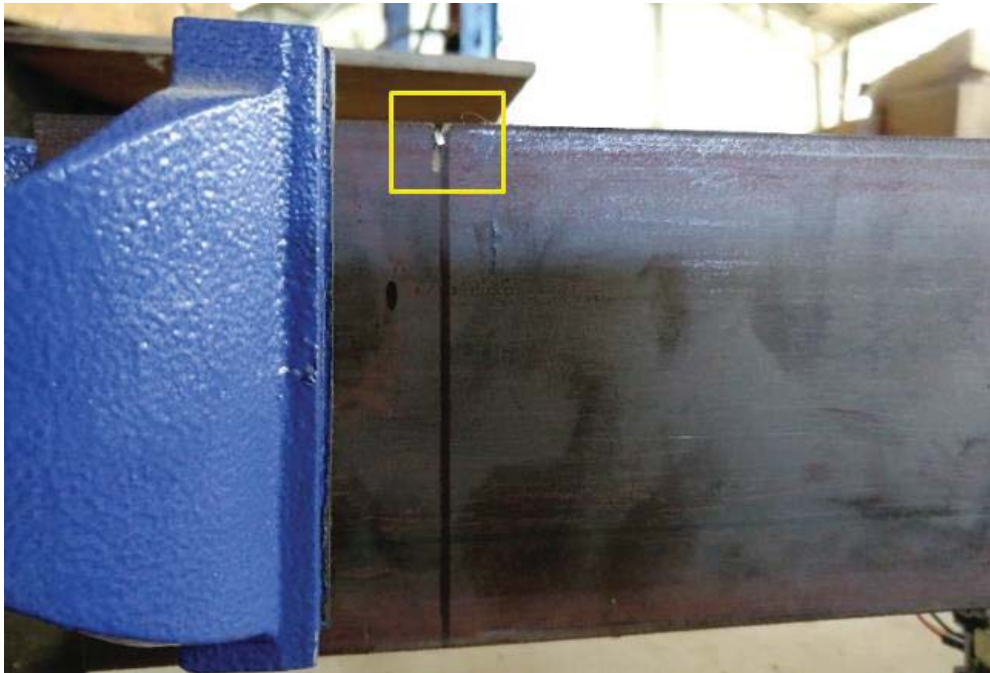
Viga con grieta incipiente, 2 [mm] de profundidad.
